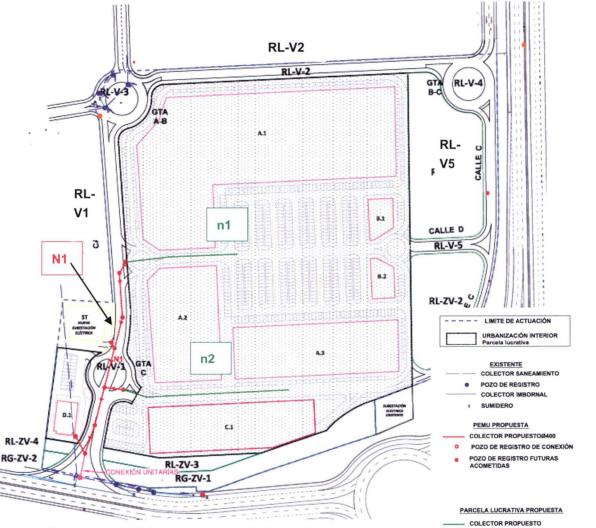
Plano de saneamiento existente y propuesto (residuales).
